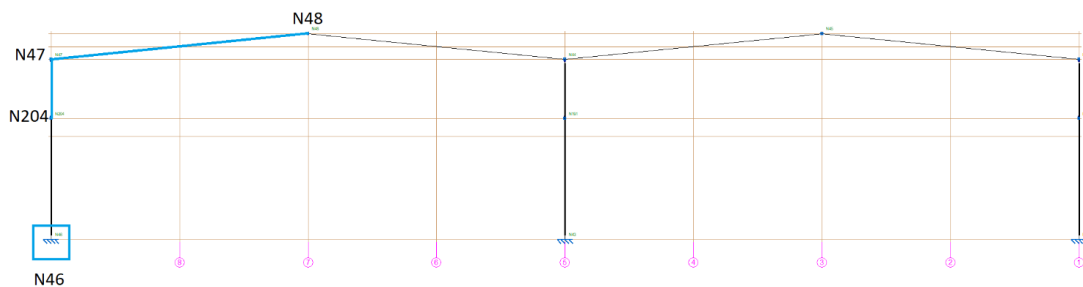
Nudos y vigas elegidos del pórtico interior.
